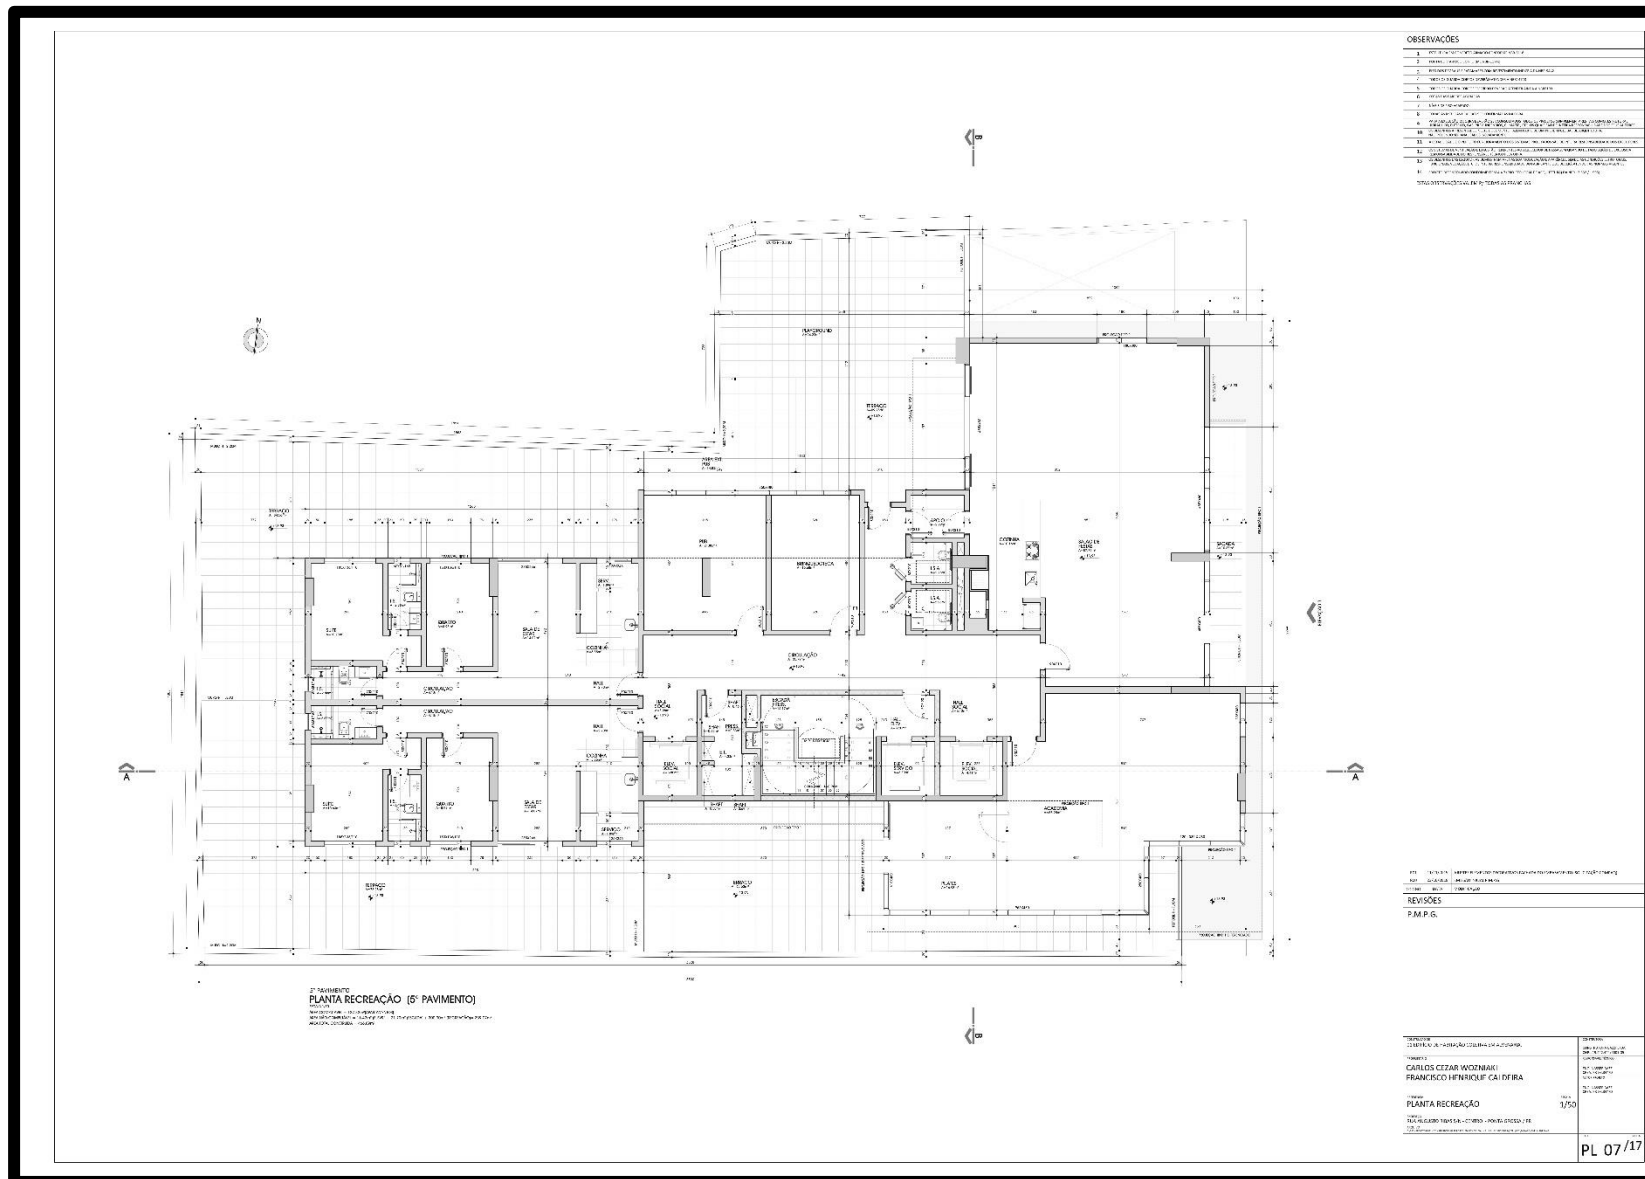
Planta área de recreação (quinto pavimento). Fonte: Construtora Bazzi (2020).
